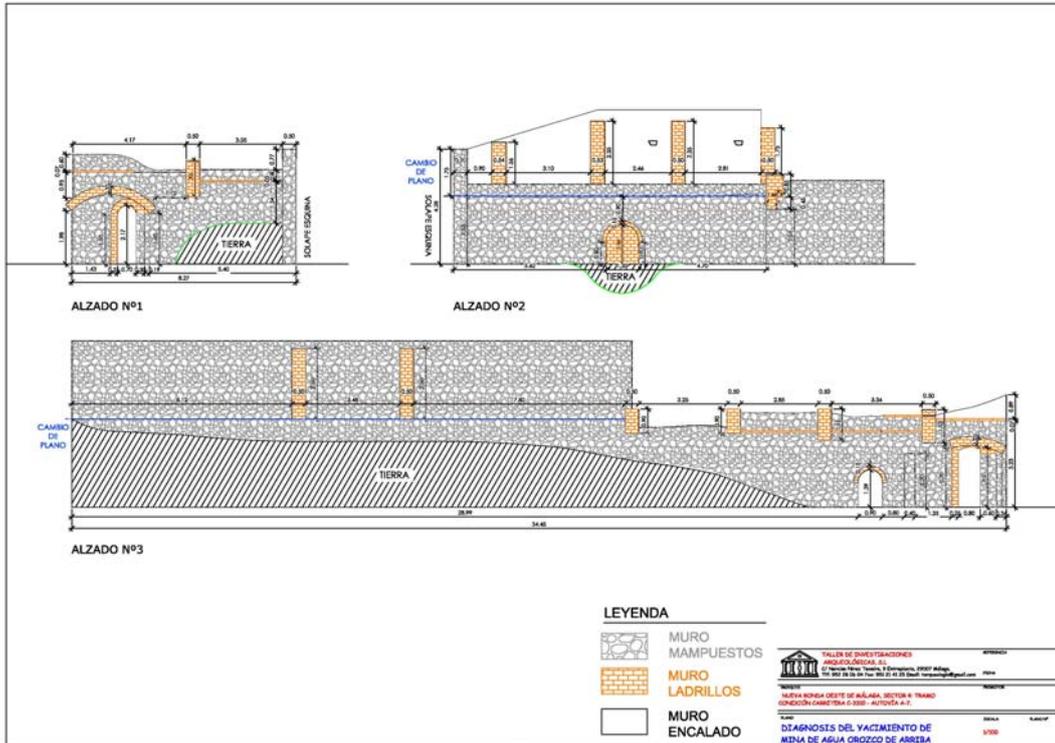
Planta de la Mina de Agua de Orozco de Arriba
